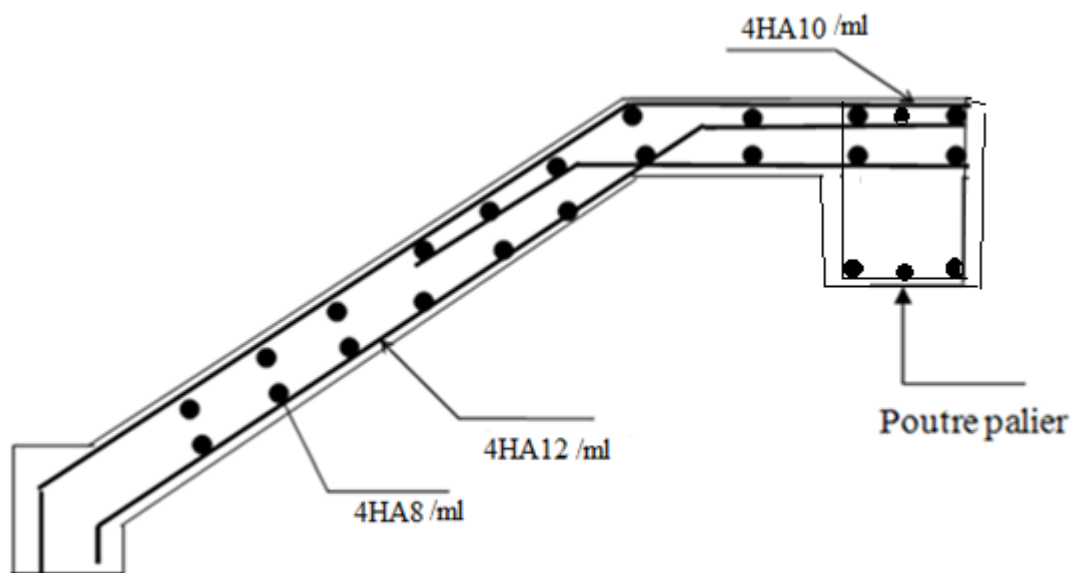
Schéma de Ferrailage de l'escalier de RDC et les étages courant
